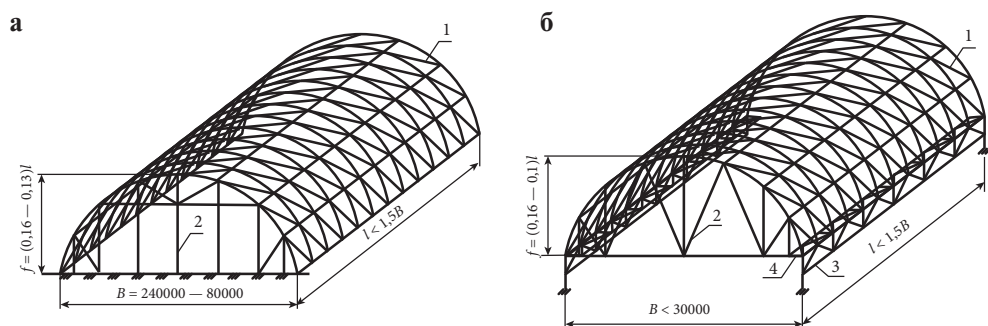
Формы однопоясных сетчатых оболочек: а) цилиндрический свод; б) цилиндрическая оболочка: 1 — сетчатая оболочка; 2 — решетчатая диафрагма; 3 — вертикальный бортовой элемент; 4 — горизонтальный бортовой элемент
